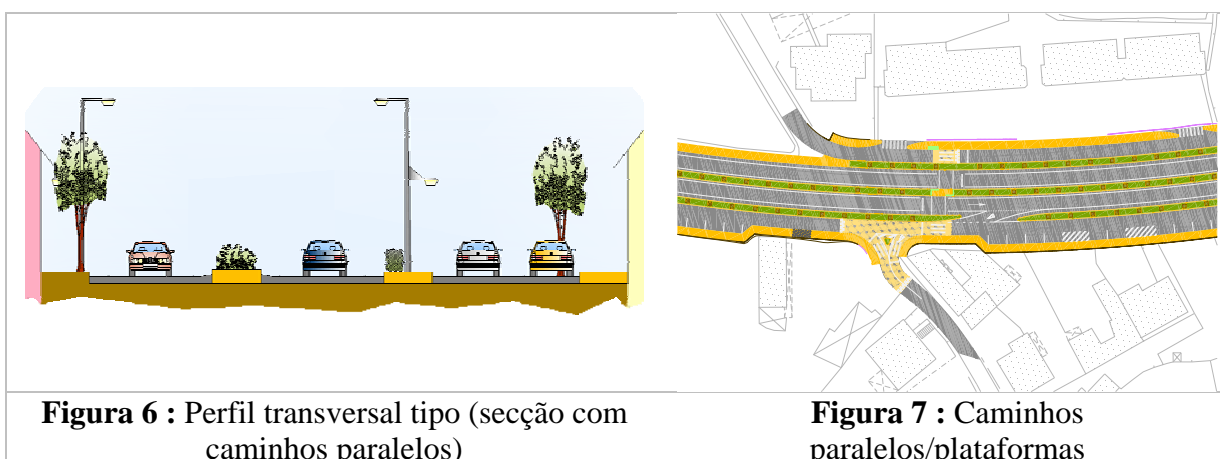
Perfil transversal tipo (secção com caminhos paralelos)
